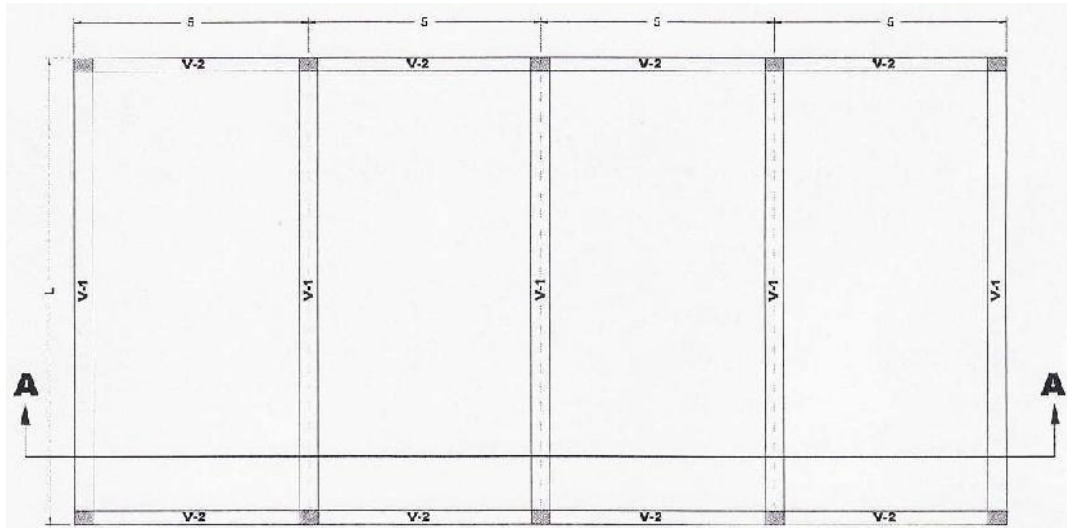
(a) Plano en Planta de una solución tradicional.
